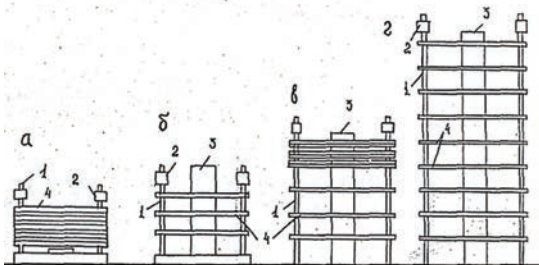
Схема возведение здания методом подъема перекрытий (1 – колонны; 2 - подъемники; 3 - ядро жесткости; 4 - плиты перекрытия)
